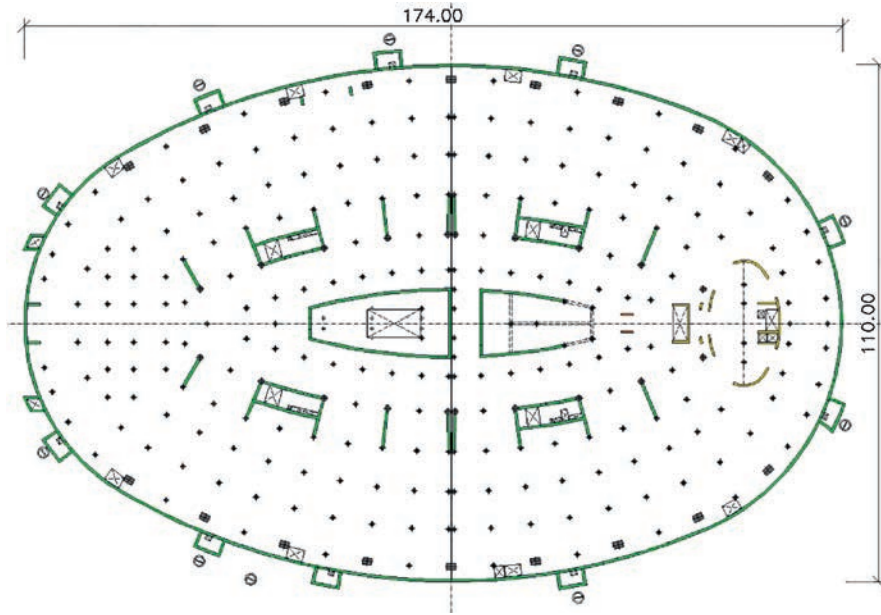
Estación Bir Mourad Rais (Argel). Plantas -2 y -1.
